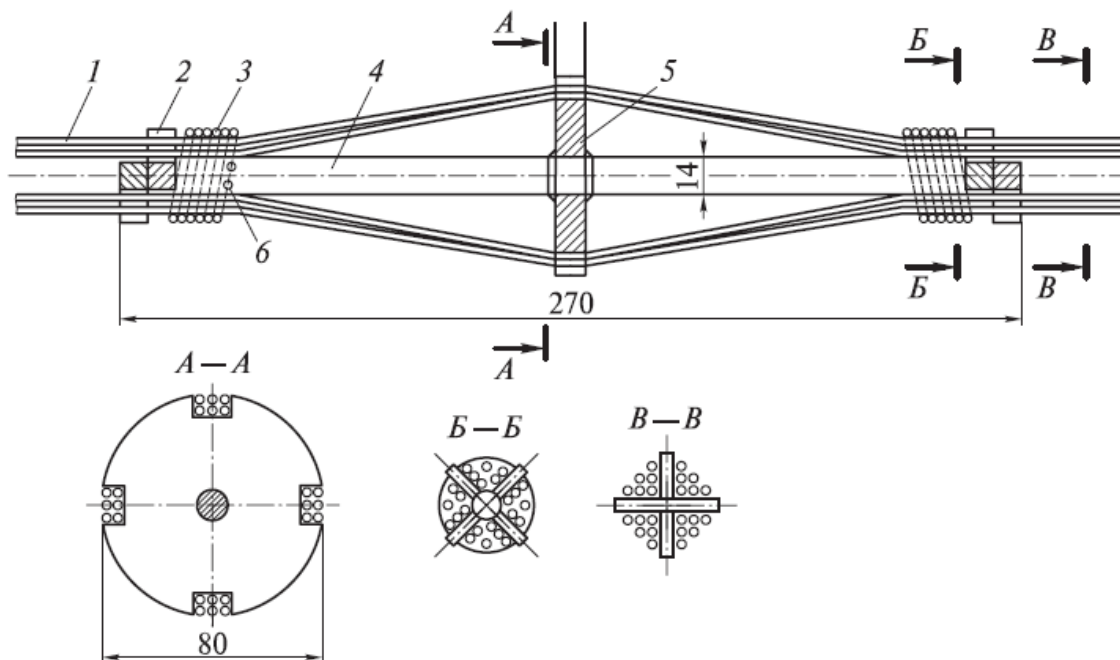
Конструкция каркасно-стрепневого анкера:
